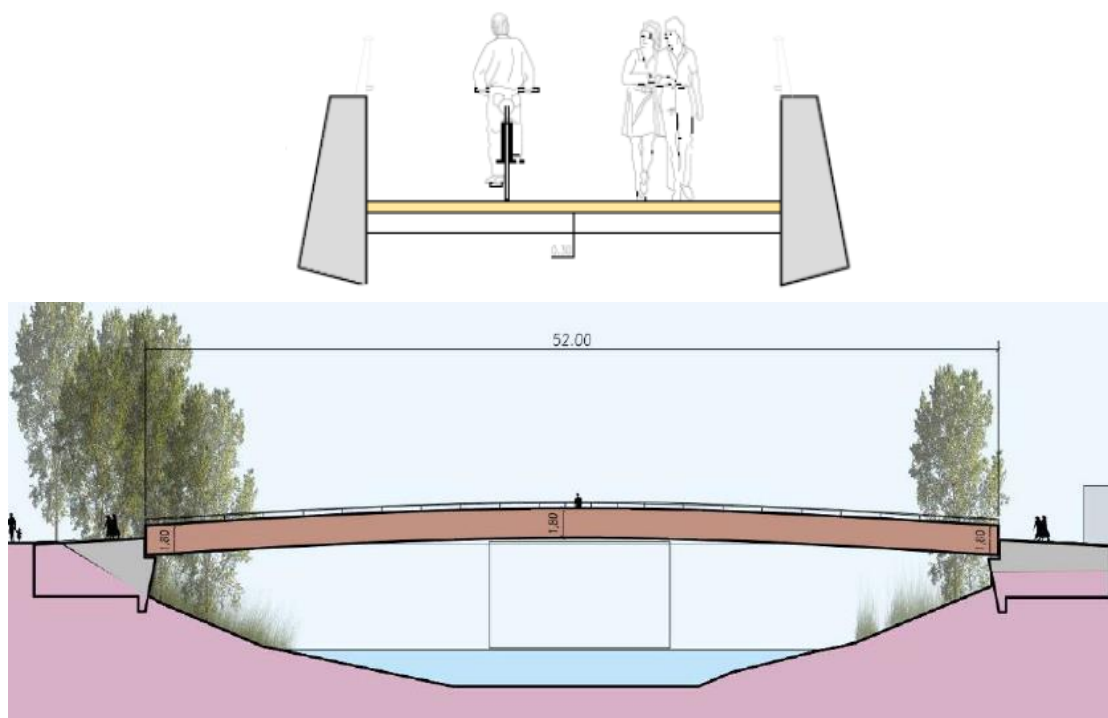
Coupe et profil en travers d'une passerelle non courante avec tablier constitué de 2 poutres latérales
